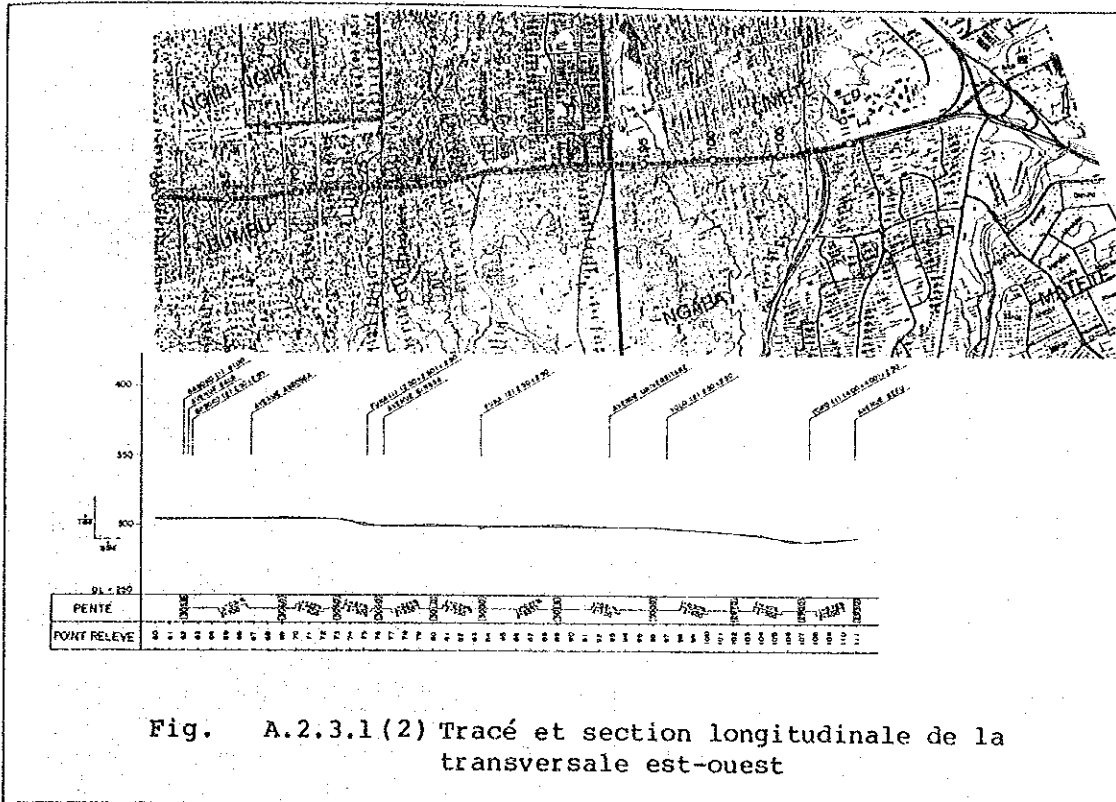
(1) Tracé et section longitudinale de la transversale est-ouest
